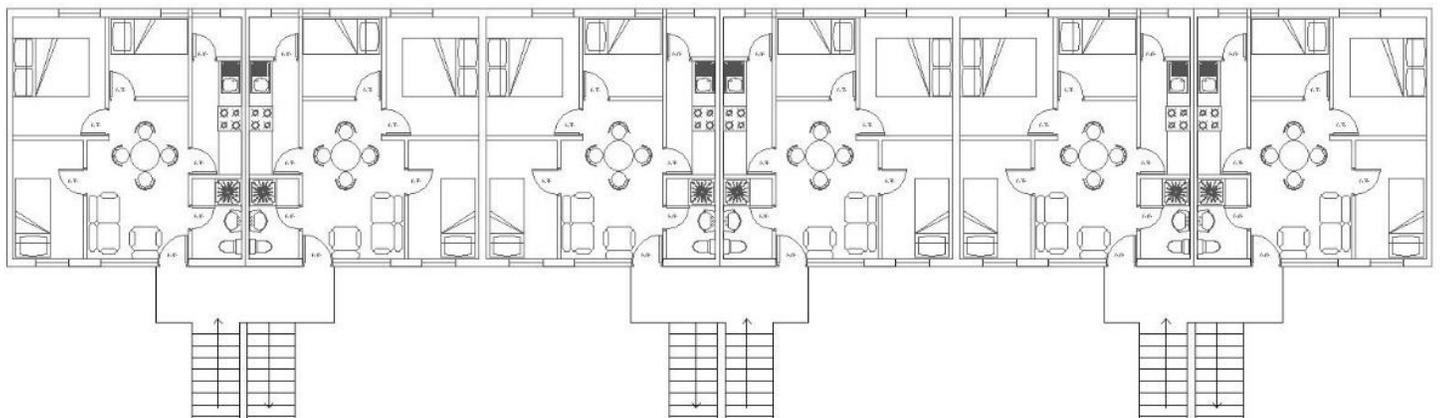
Planta Arquitectónica. Fuente: Elaboración propia.
